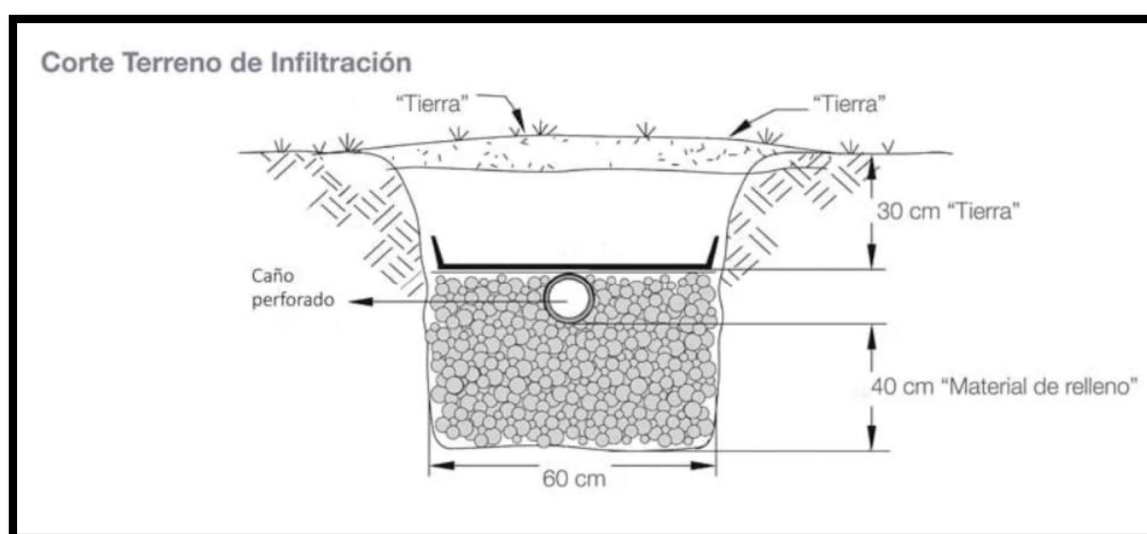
Corte Terreno de Infiltración – Fuente: Cátedra de Ing. Sanitaria
